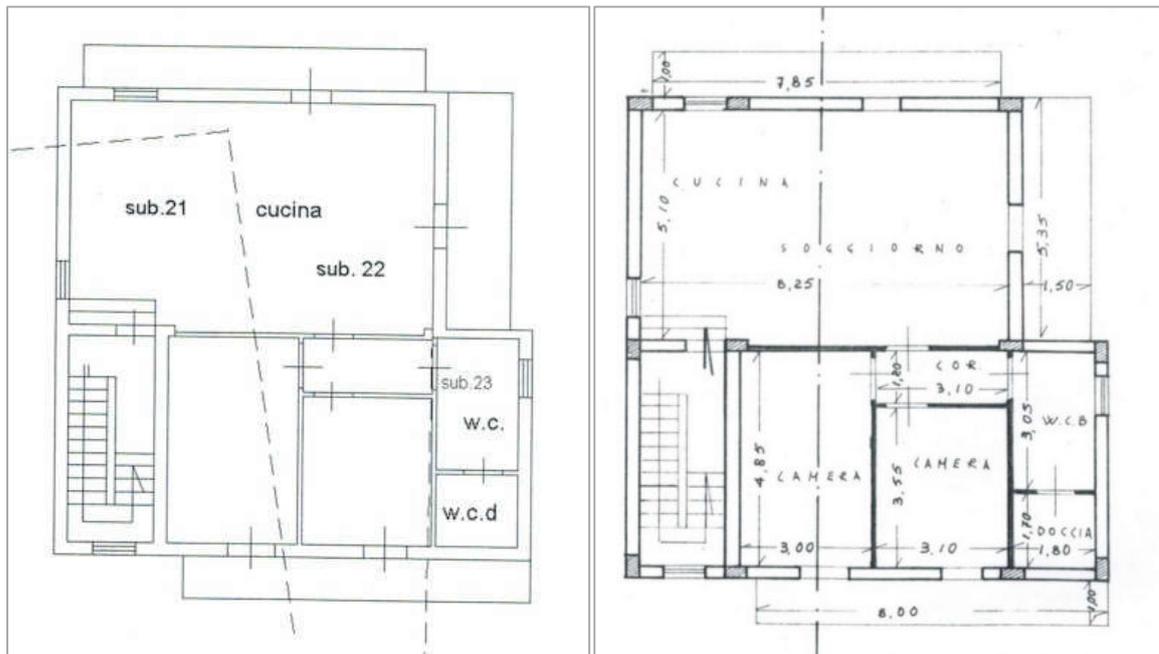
Raffronto tra planimetria catastale e planimetria di progetto
